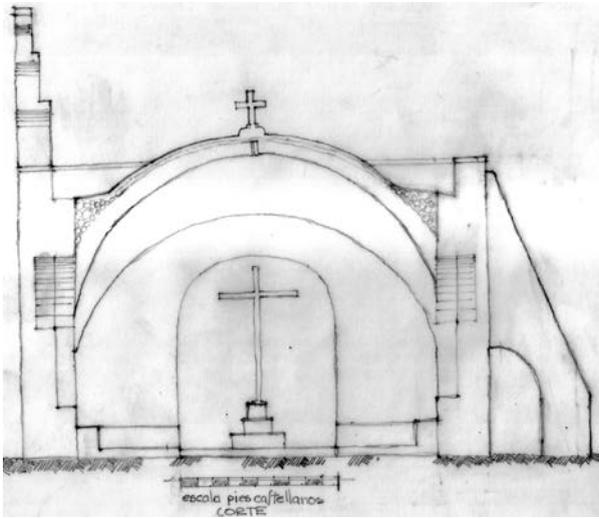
Corte "cámara de los secretos", patrón 10 pies.
